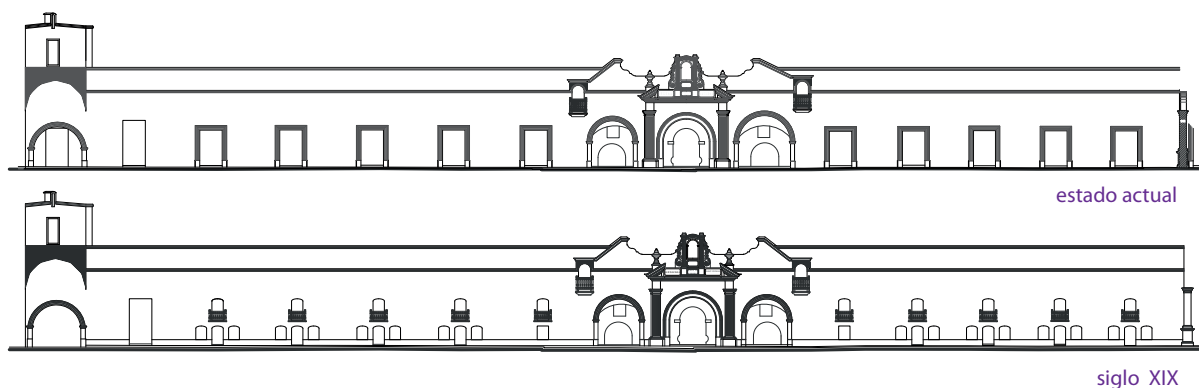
Diferentes fachadas de la cortina norte. Levantamiento y dibujo: INAH.
